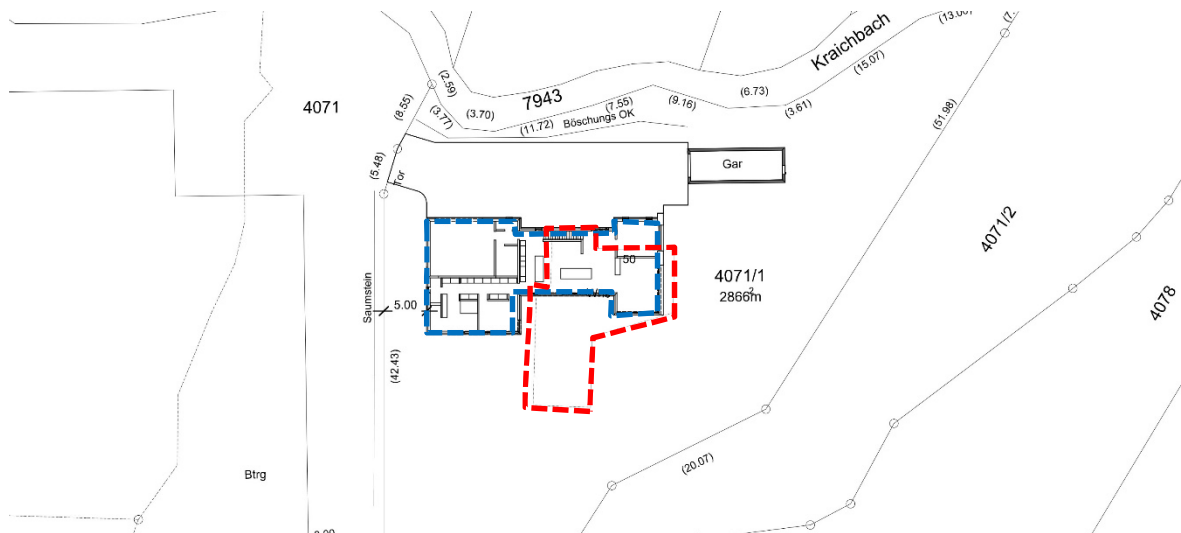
Lageplan mit Bestandsgebäude (rot) und geplanten Gebäude (blau)
